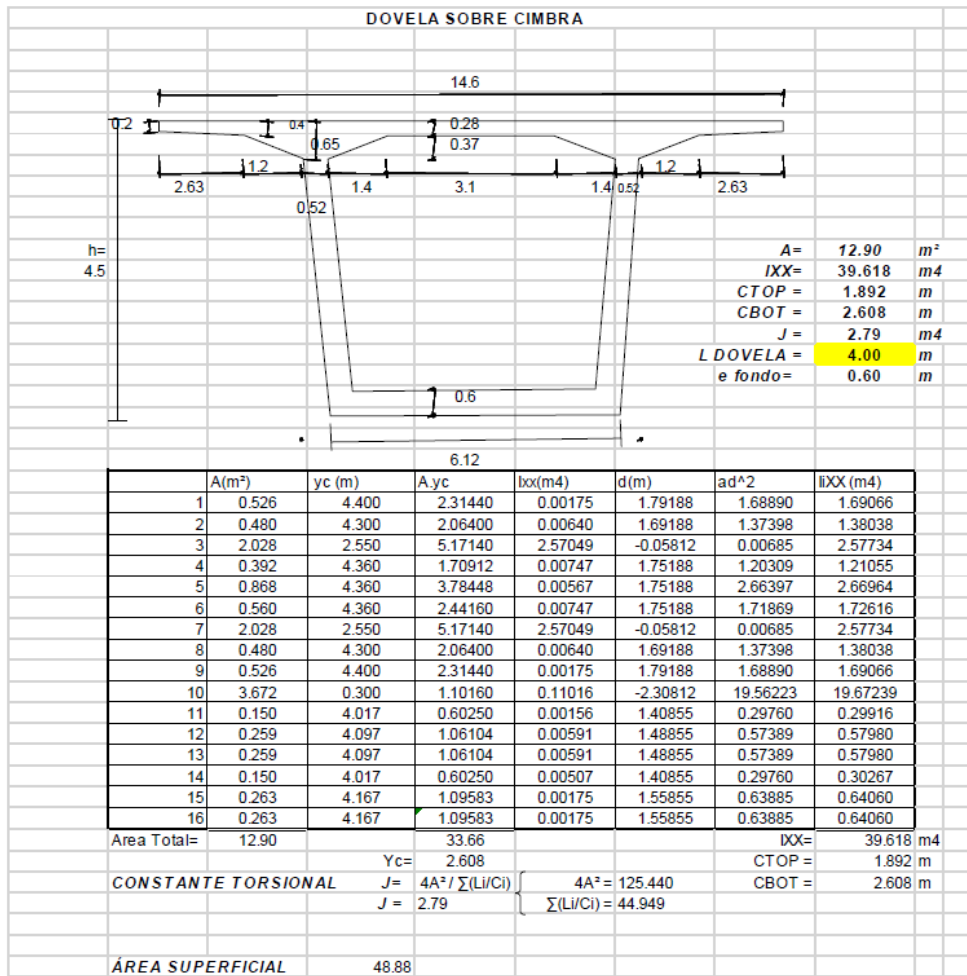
Dimensiones y propiedades de la viga cajón dovela sobre cimbra puente San Pedro.
